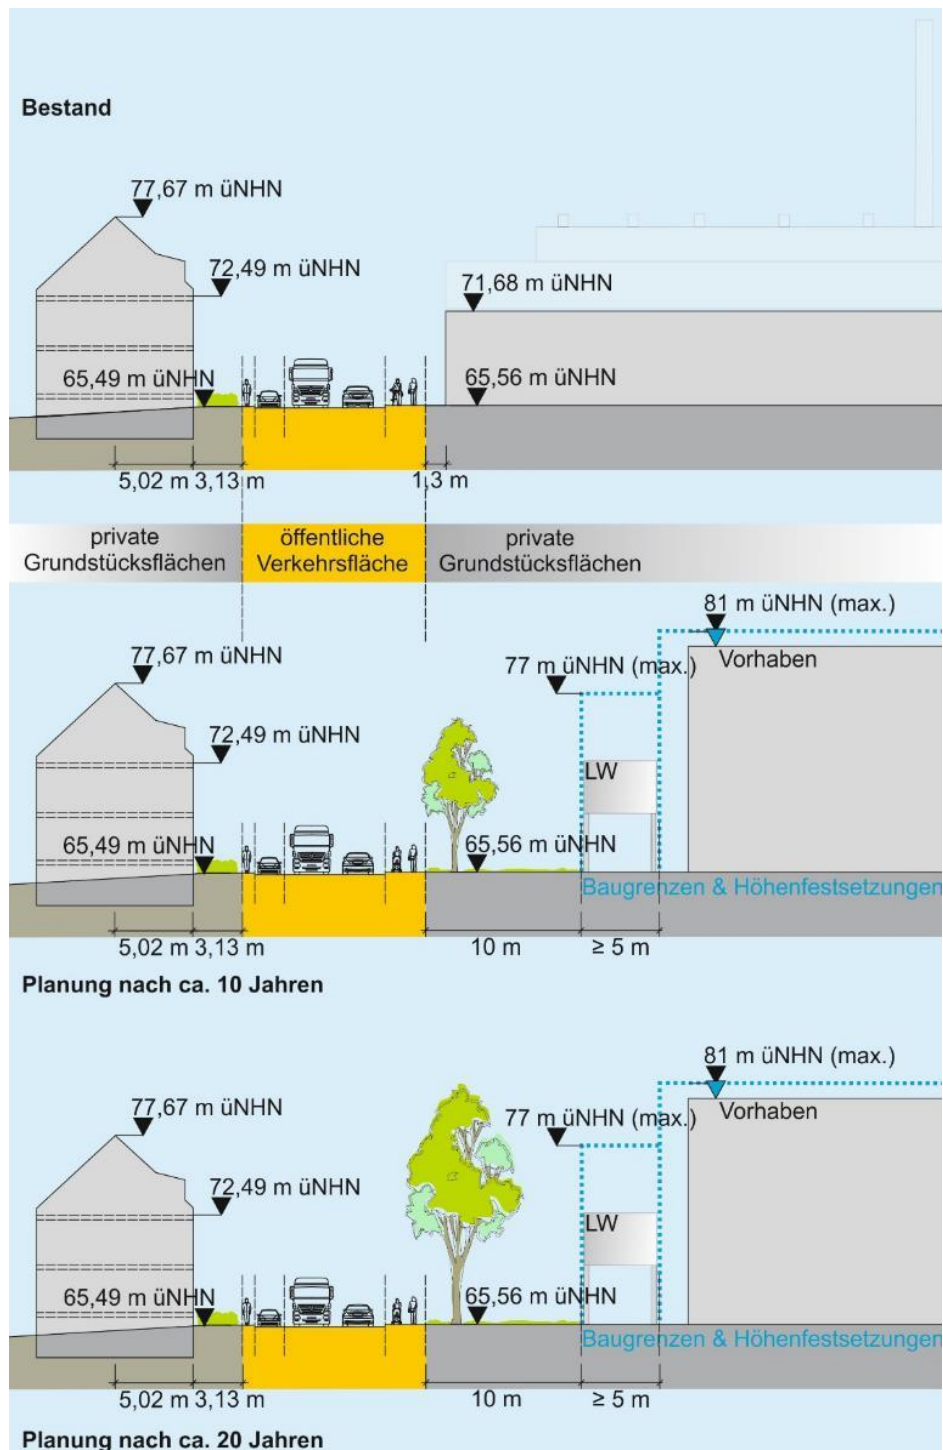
Schnitt Bestand und Planung nach ca. 10 sowie nach ca. 20 Jahren im Bereich Dülkener Straße 163-169 (unmaßstäblich)¹² (LW = Löschwassertank / -zisterne)
